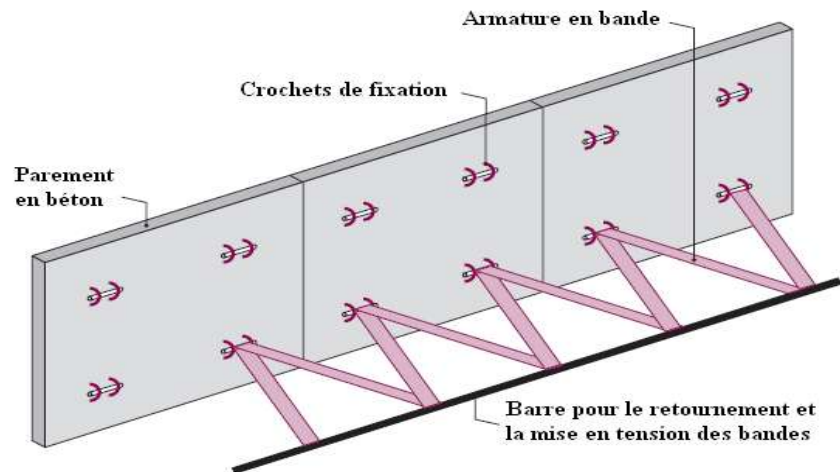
Pose et fixation des armatures sur les écailles de parement.
